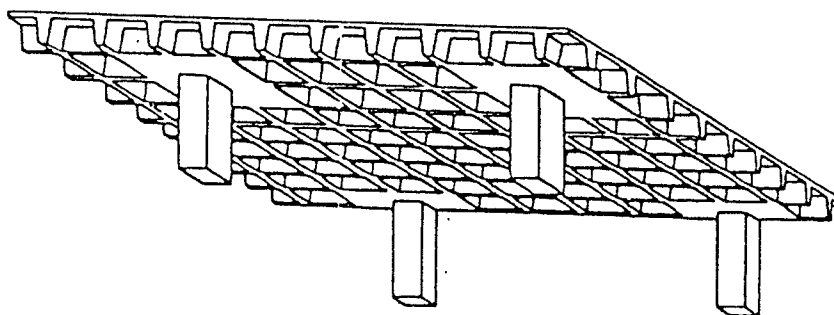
Losa Nervada en dos sentidos (Waffle Slab)
